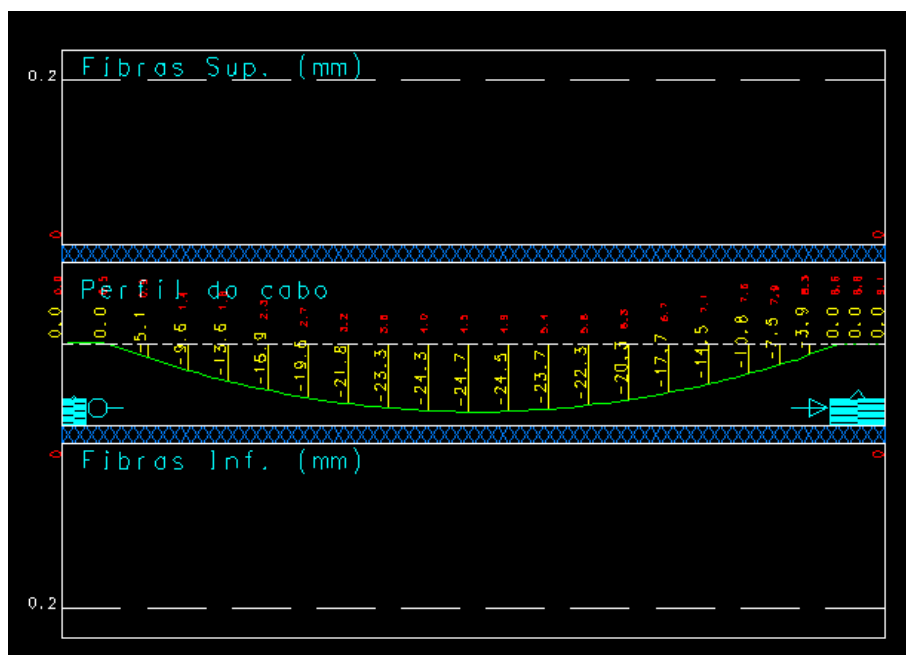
Fissuração viga V15 do 2º pavimento (CAD/TQS)
